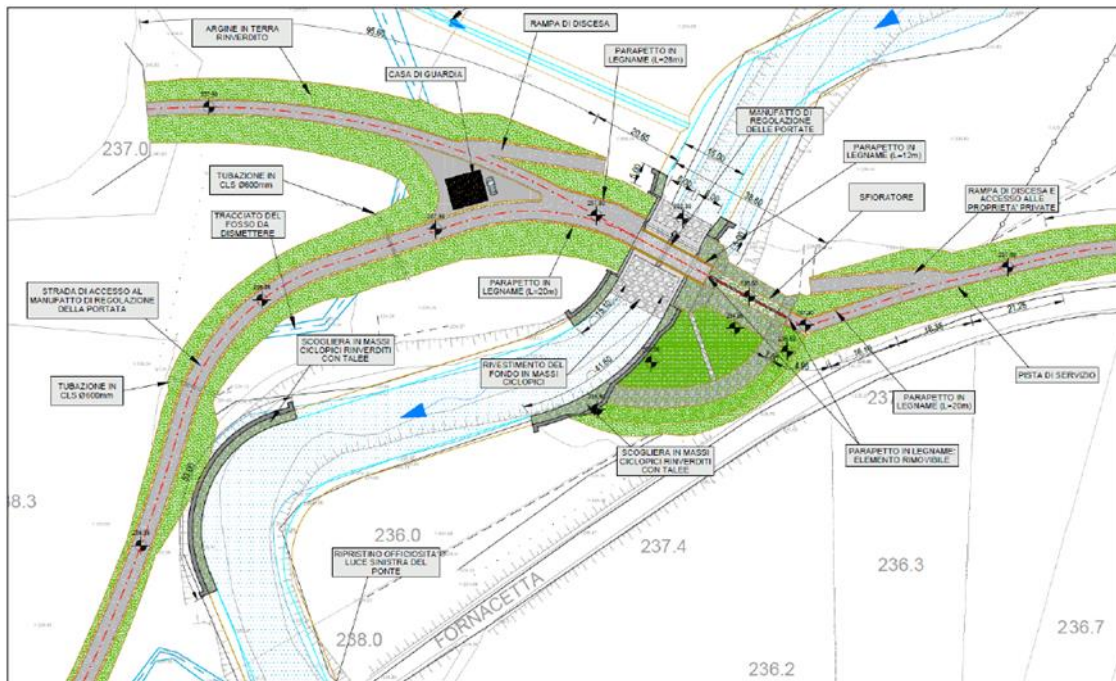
Planimetria di progetto del manufatto di regolazione dell'area di laminazione di Inverigo
